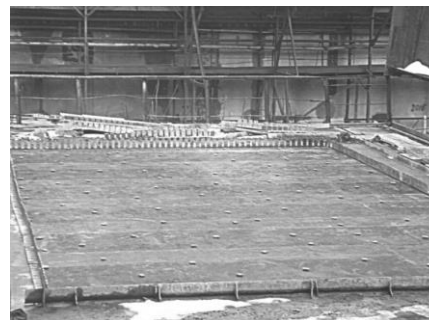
Форма-матрица для изготовления плоских железобетонных секций
